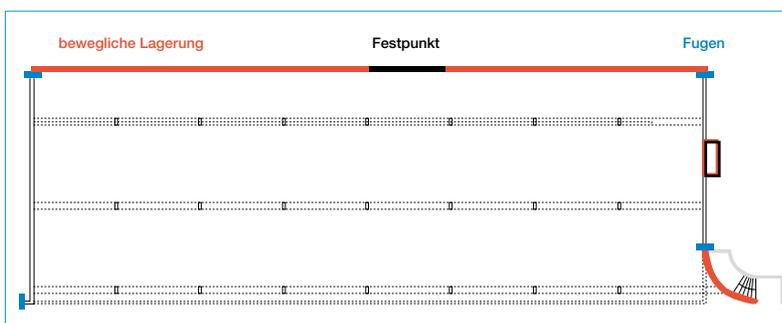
Grundriss des Parkdecks mit geplanter beweglicher Lagerung
